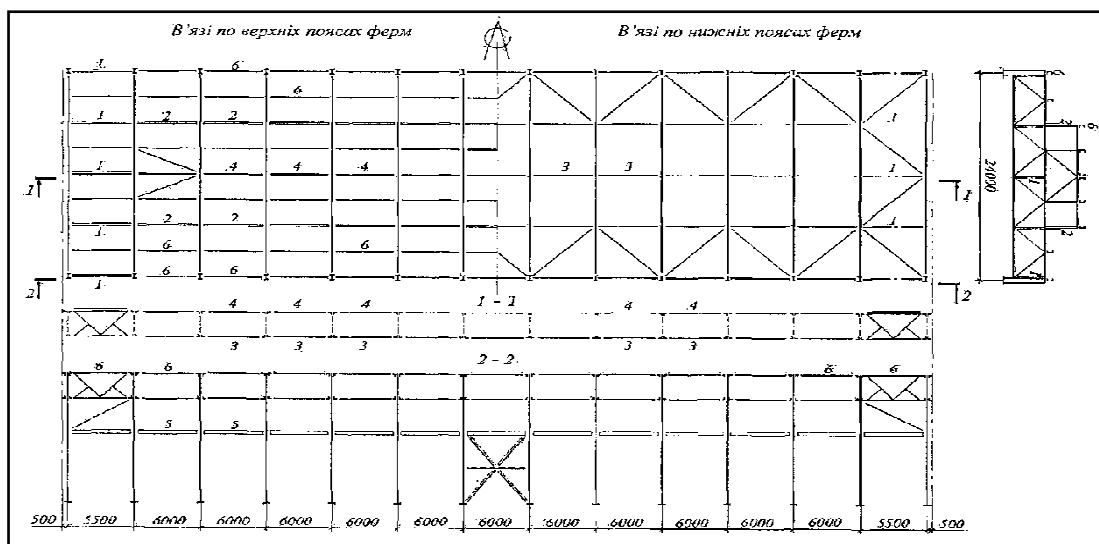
Схема в'язей каркаса при прогонному рішенні та кроці ферм 6 м: 1 – вертикальні в'язі між фермами; 2 – ліхтарна панель; 3 – розтяжка; 4 – розпірка; 5 – підкранова балка; 6 – прогони
